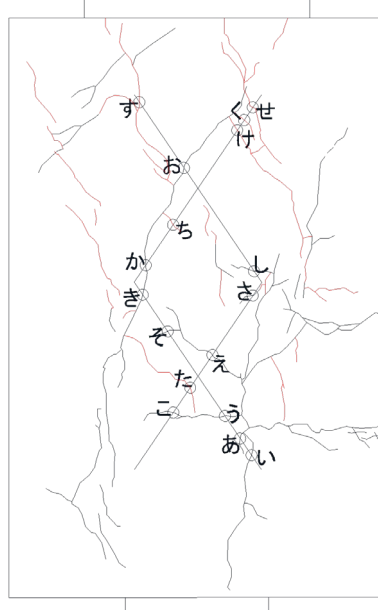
パイルキャップひび割れ幅測定位置 (試験体 D-2 正載荷)
